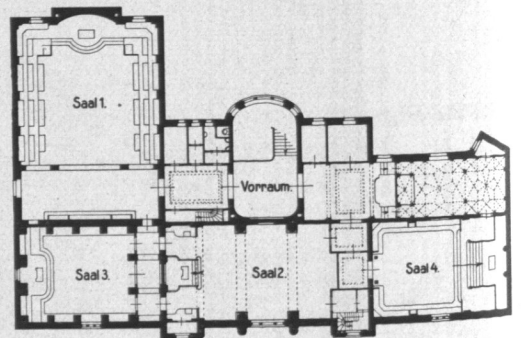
Provinzialloge von Niedersachsen, Obergeschoss, Grundriß.
